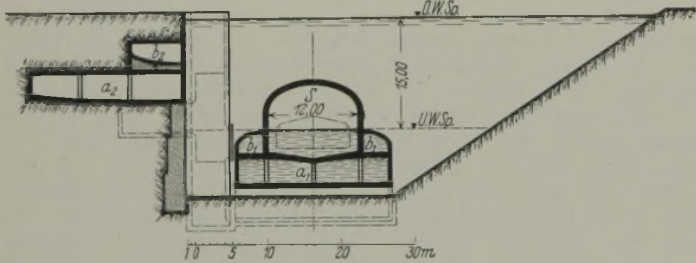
Tauchtrog mit gewölbter Decke in Unterwasserstellung, zweistöckige Bauweise.
